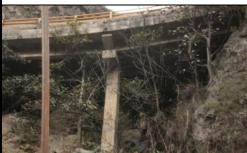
VISTA PANORAMICA LONGITUDINAL
